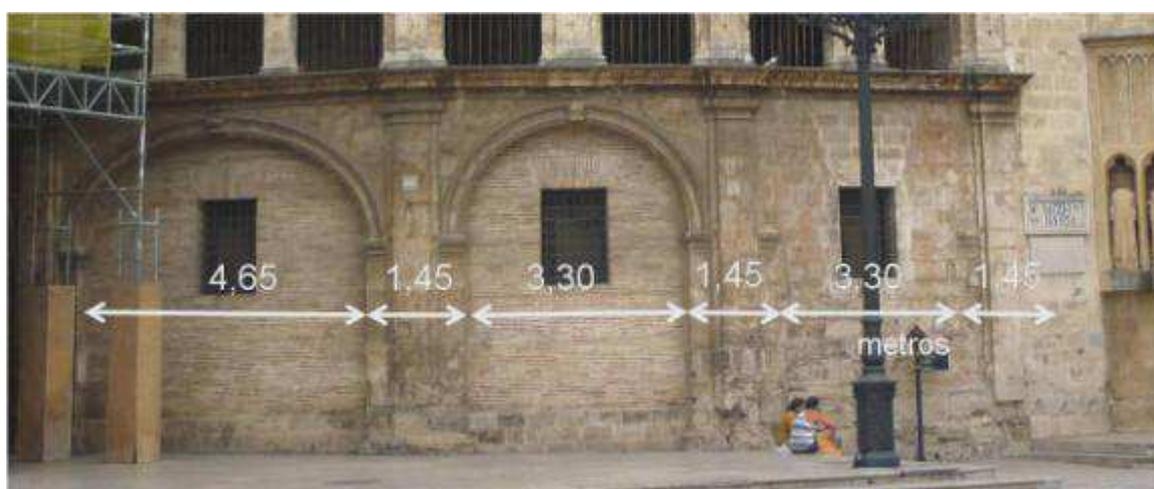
17.6 Relación modular del trazado en planta visto en el alzado real.
